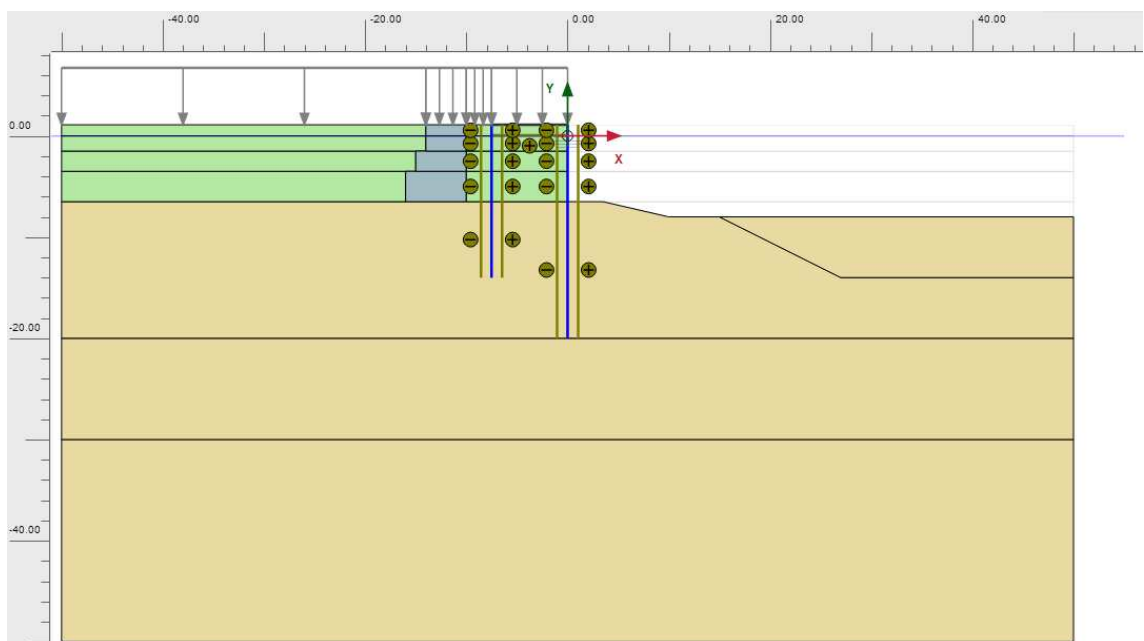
Fase 5 - Infissione paratia di ancoraggio e getto solettone in c.a.
